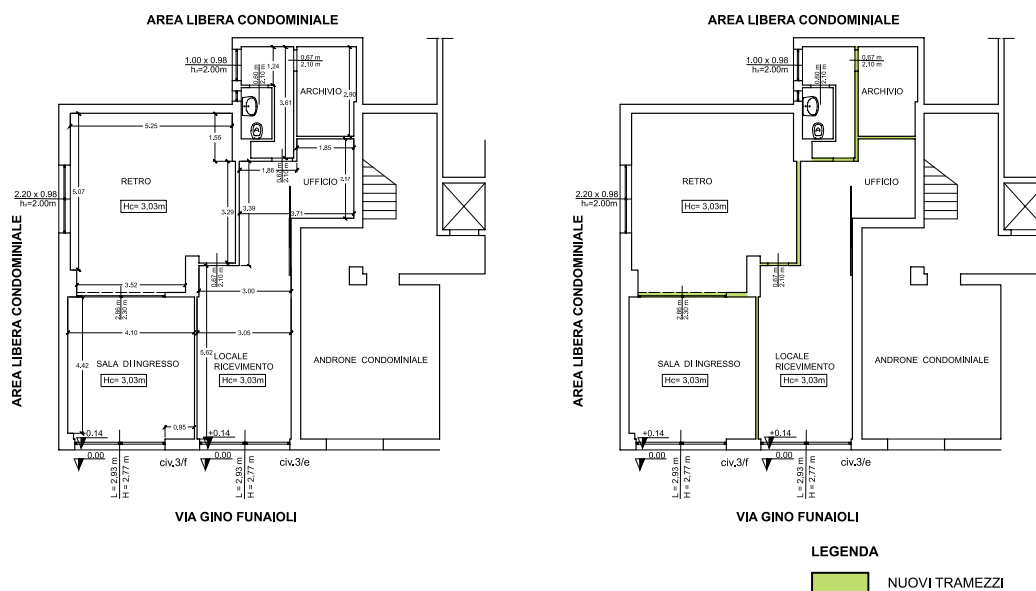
Rilievo e Sintesi delle modifiche rispetto alla configurazione originaria
